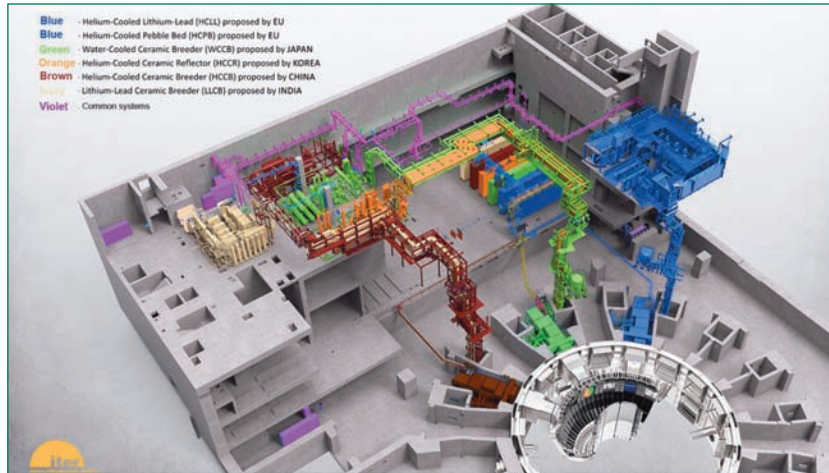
ITER - sistemas de refrigeración alternativos (TBM).
